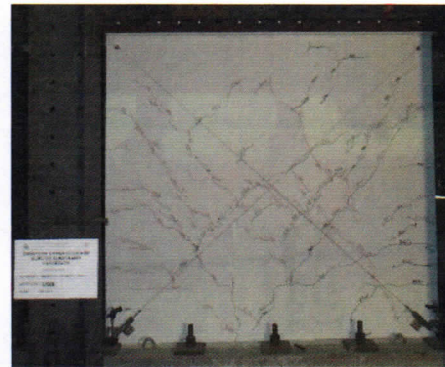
Continuación y nuevas grietas diagonales paralelo a la diagonal principal para una distorsión 1/550 Vista cara Norte.
